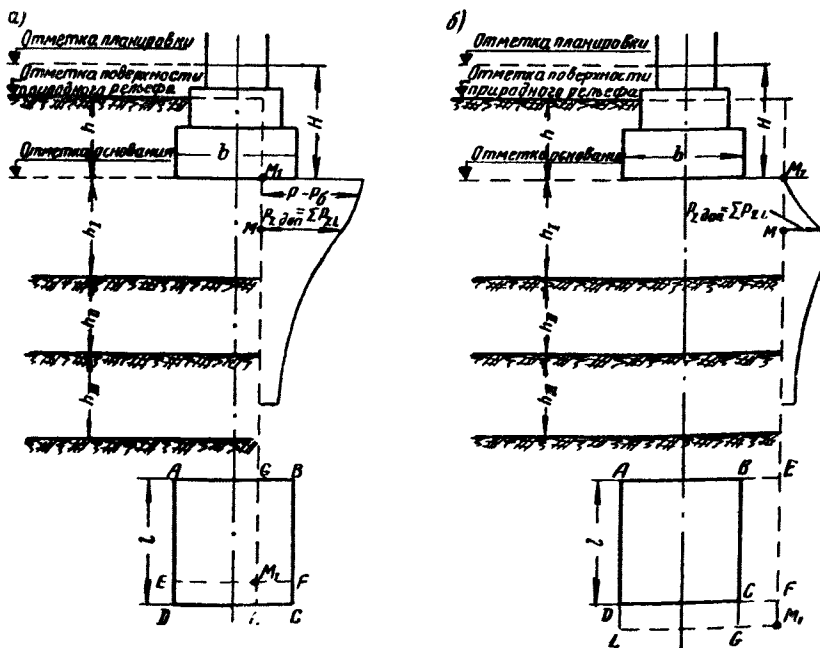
(2). Расчетные схемы распределения давлений по вертикали, проходящей через любую точку основания, проекция которой расположена а — внутри контура подошвы фундамента; б — вне контура подошвы фундамента
